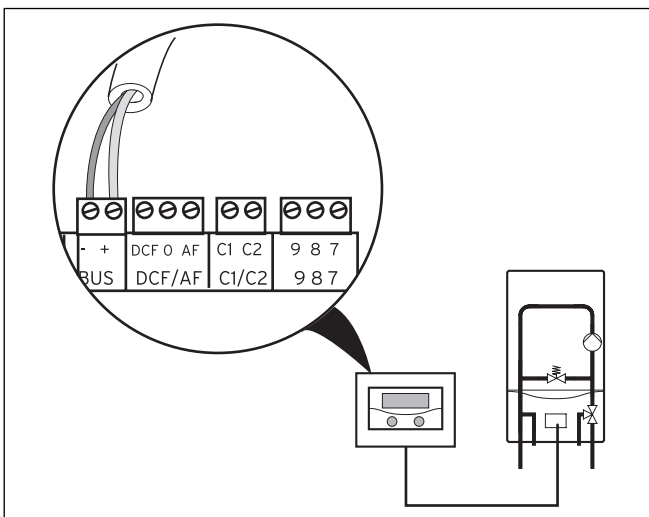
Collegamento dell'apparecchio di riscaldamento
